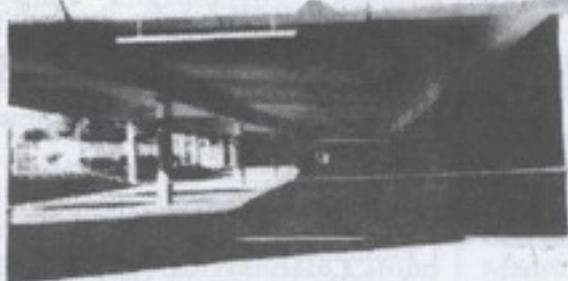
Edificio de estacionamiento de dos niveles. Estructura de concreto reforzado colado en sitio, formada por pórticos en un sólo sentido ortogonal; ausencia de vigas de amarre y acción de pórtico en el sentido transversal.
